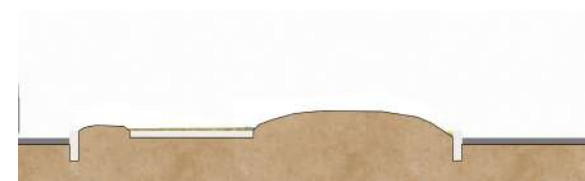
Tramo 1 estado actual. Fuente: Elaboración propia
